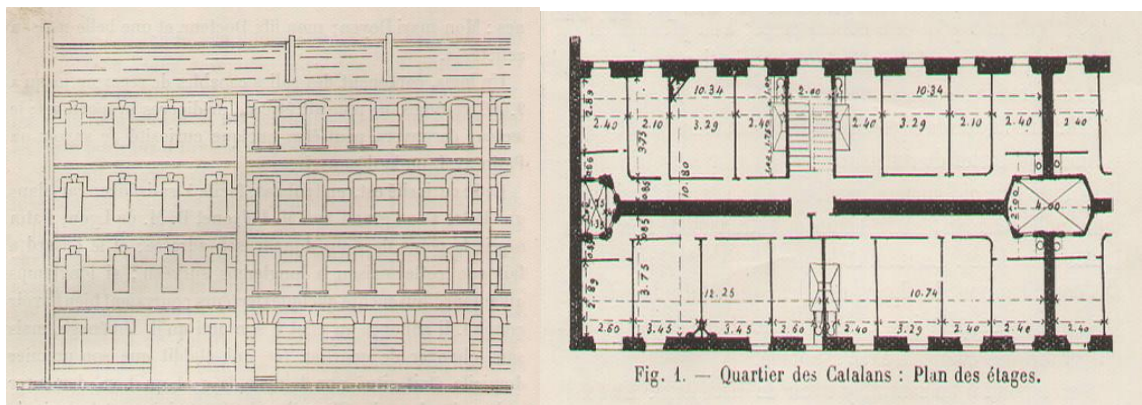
Logement ouvrier (quartier des Catalans, France) : façade et plan d'étage courant
